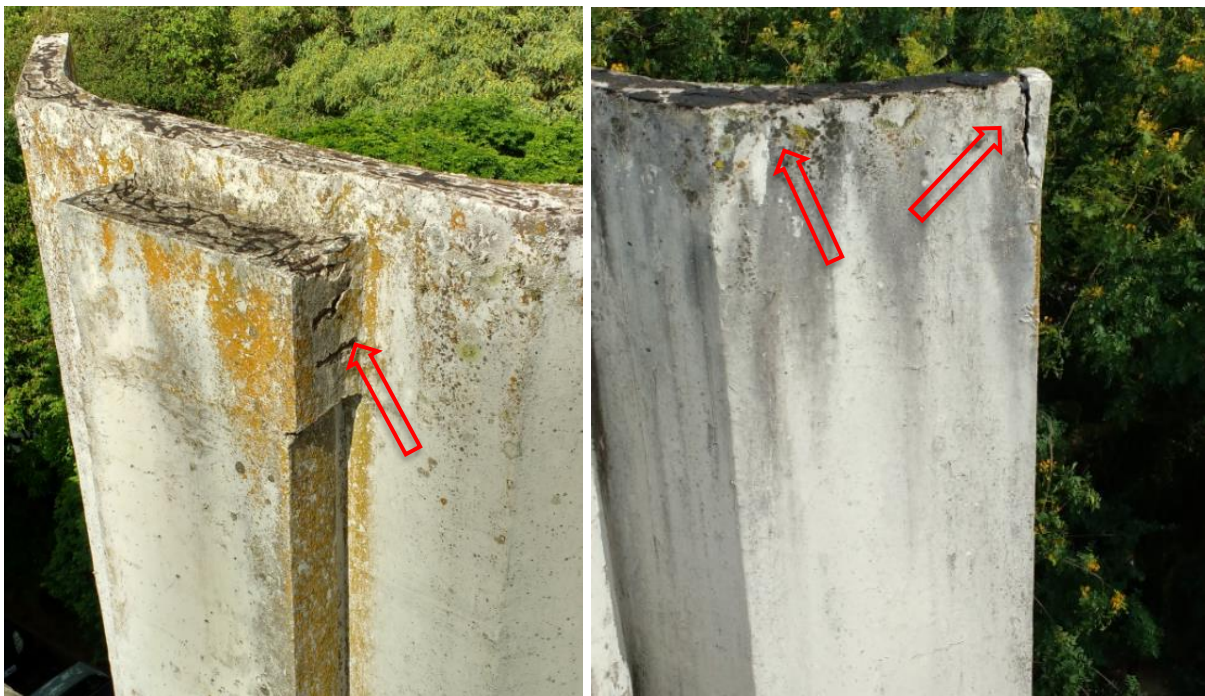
armaduras expostas, eflorescência e danos no concreto (deslocamento).
